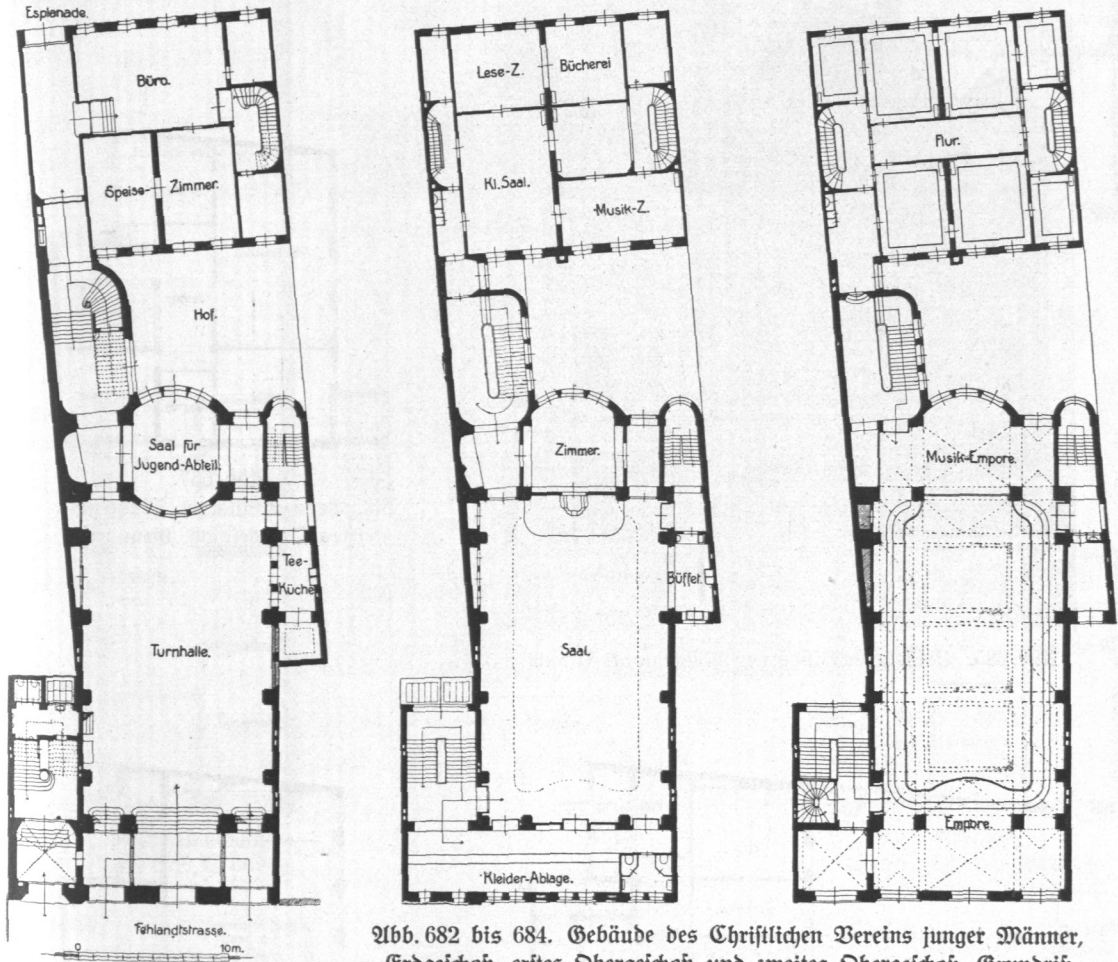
bis 684. Gebäude des Christlichen Vereins junger Männer, Erdgeschoss, erstes Obergeschoß und zweites Obergeschoß, Grundriß.
